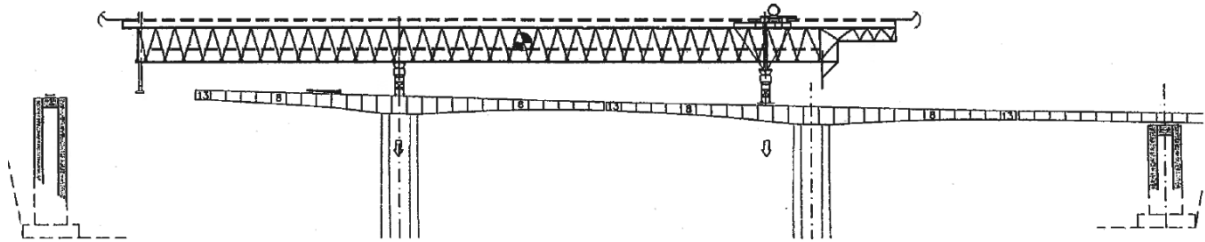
Acção da lançaadeira sobre a superestrutura na fase de betonagem da junta de fecho.
